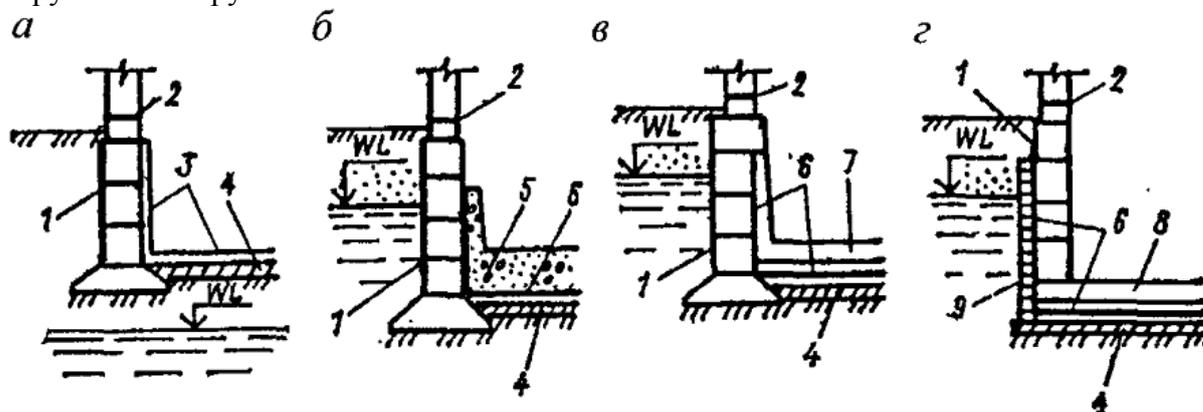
Гидроизоляция подвальных помещений: 1 – обмазка; 2 – гидроизоляция между фундаментом и стеной; 3 – цементный слой и плитка; 4 – подготовка; 5 – пригрузочный слой бетона; 6 – рулонная гидроизоляция; 7 – железобетонный кессон; 8 – фундаментная плита; 9 – защитная стенка из кирпича
